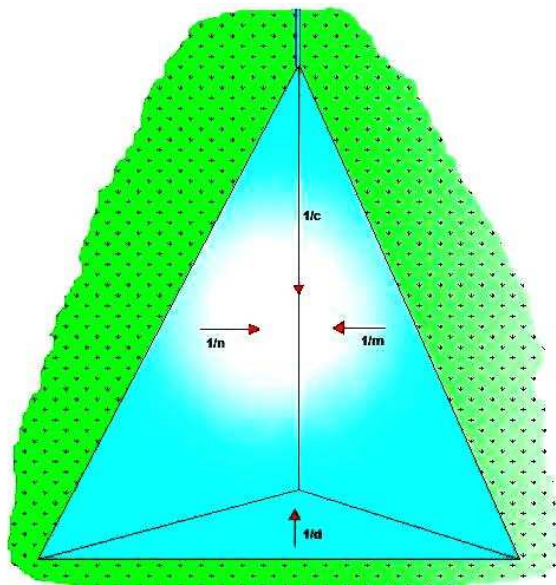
Planta da bacia de retenção com geometria piramidal.
